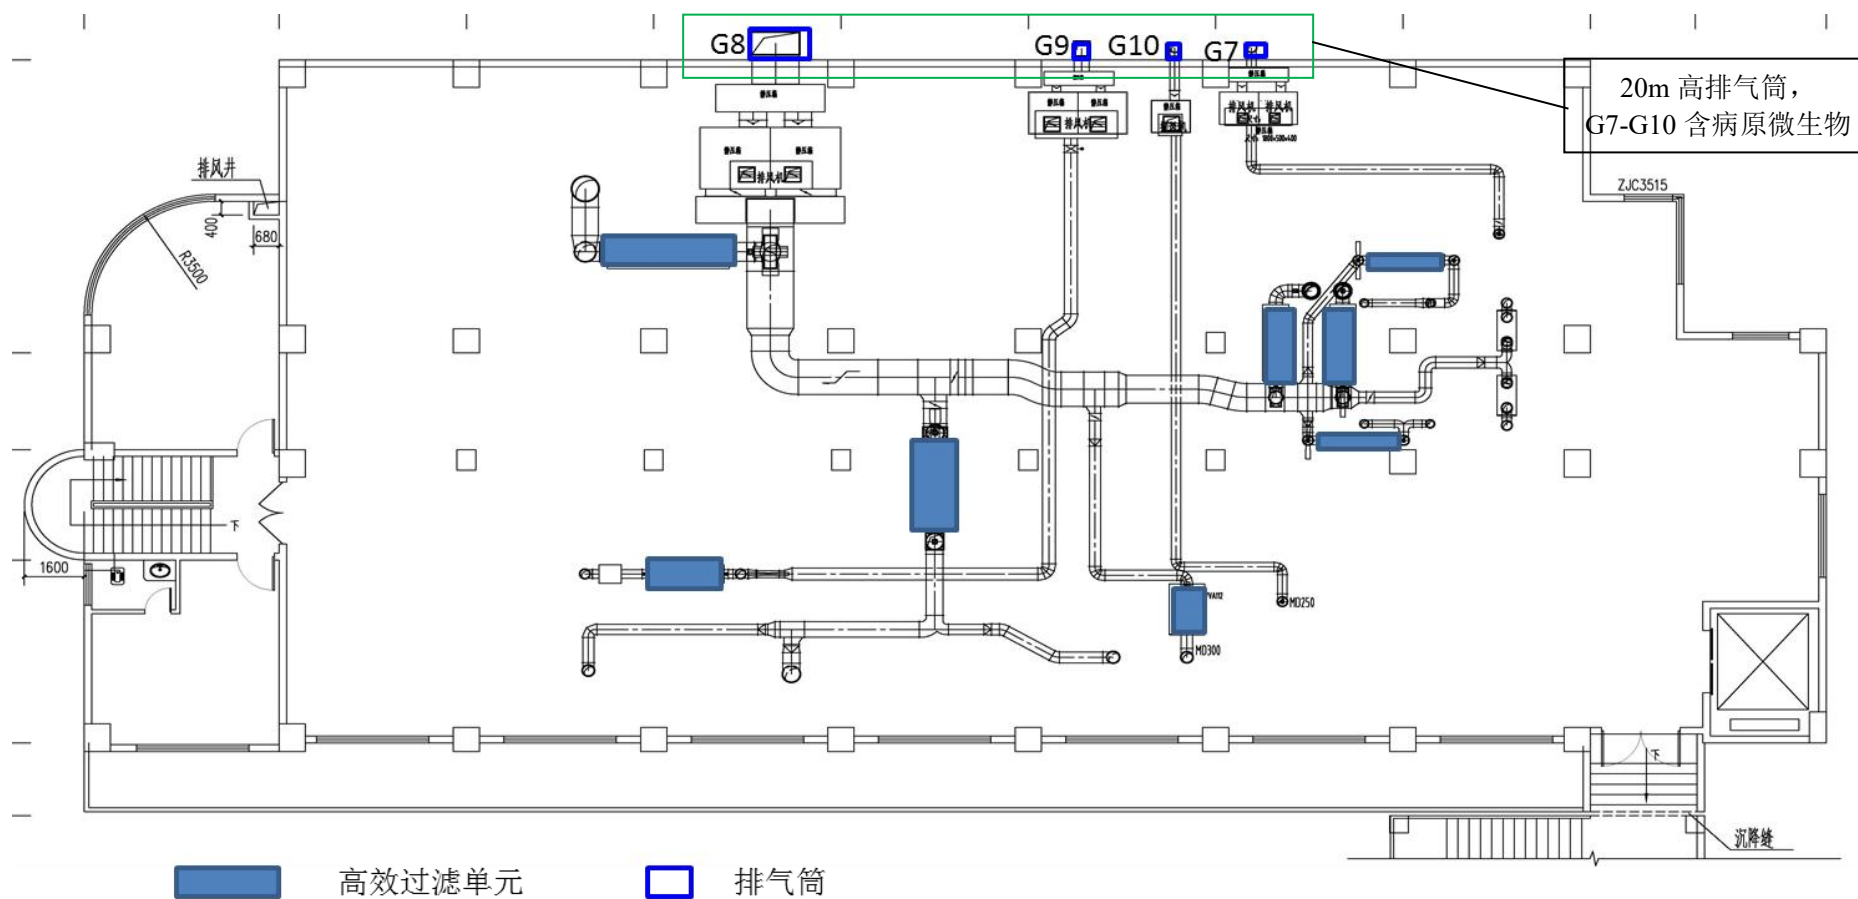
废气治理设施（科研楼北楼 4 层）平面布置图
